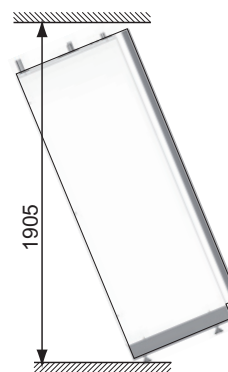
Dégagement minimum pour installation de la pompe à chaleur.
